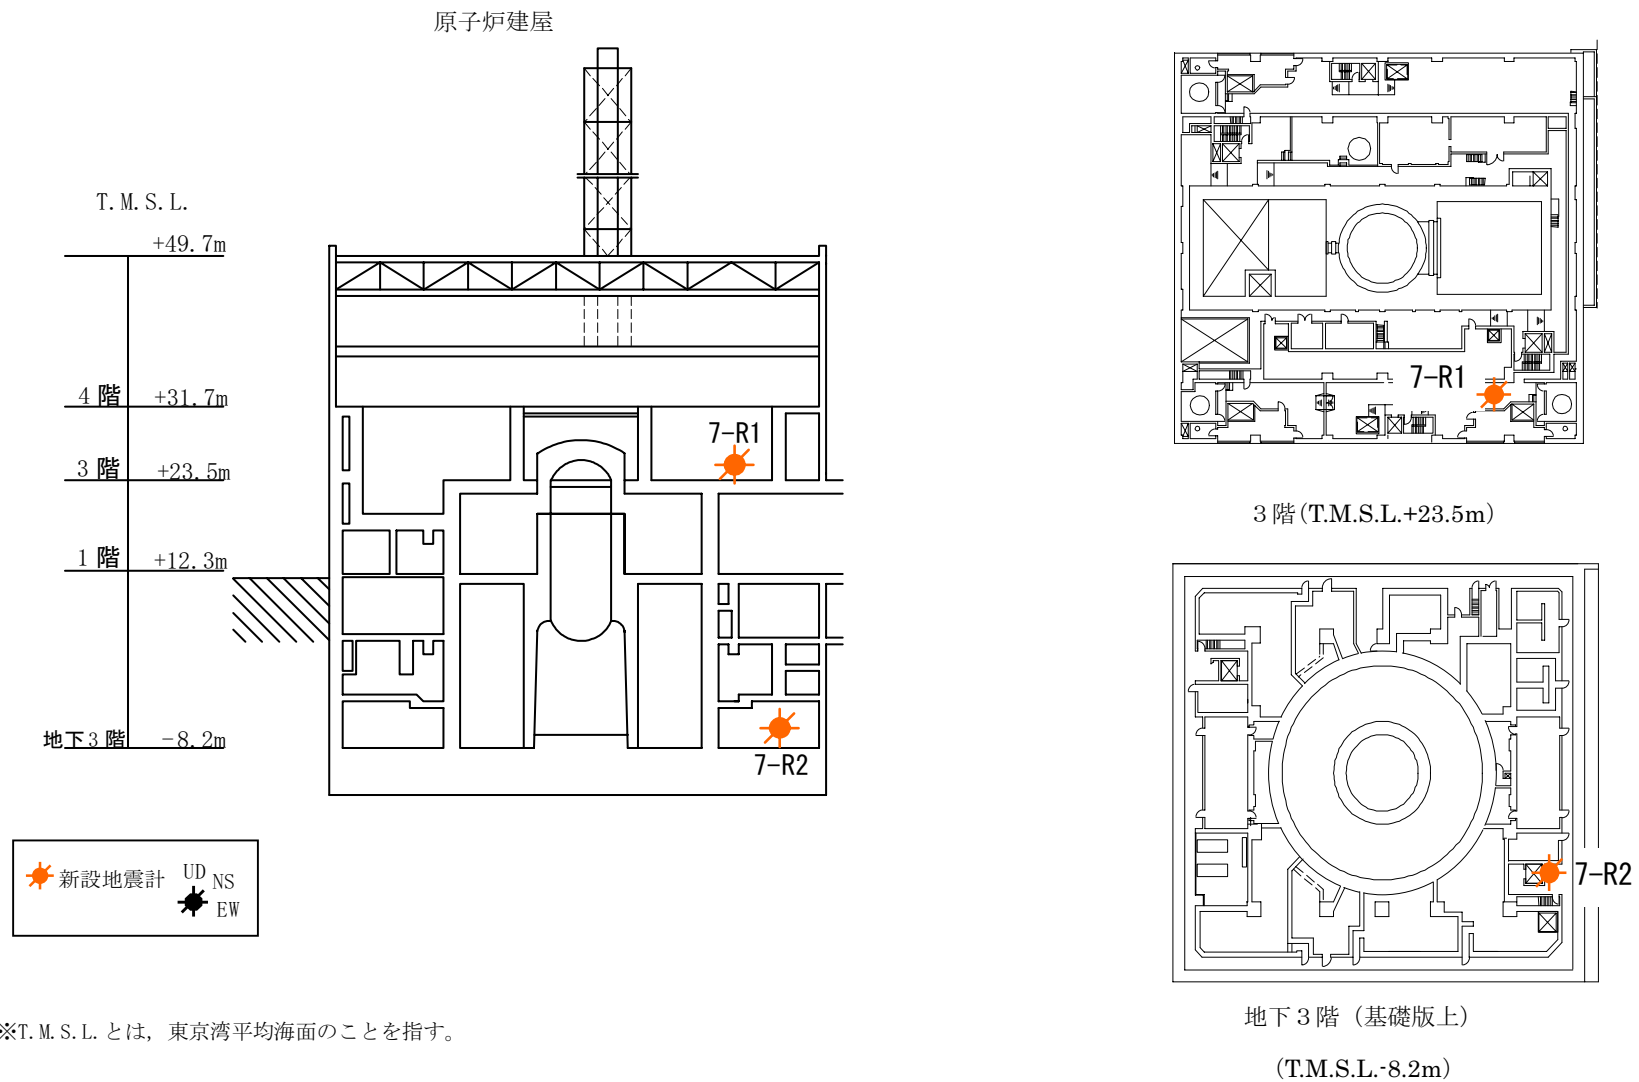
7号機原子炉建屋地震計配置断面図および平面図
